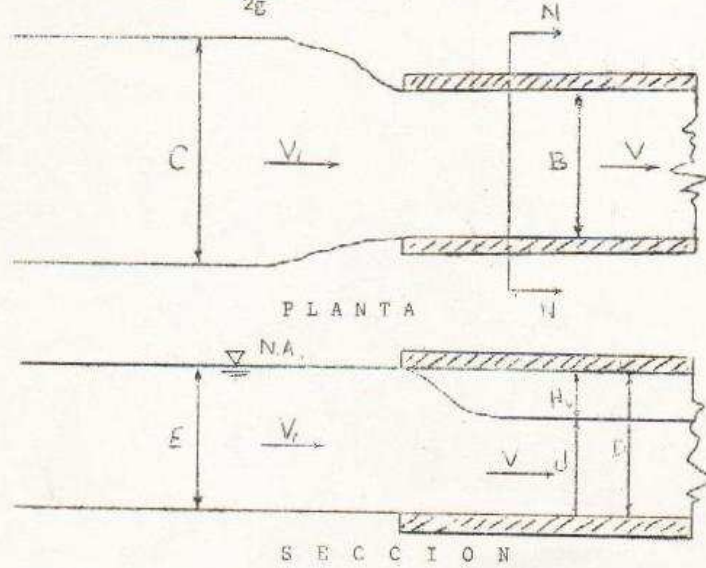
Planta y sección longitudinal de una alcantarilla rectangular mostrando elementos de flujo crítico.
